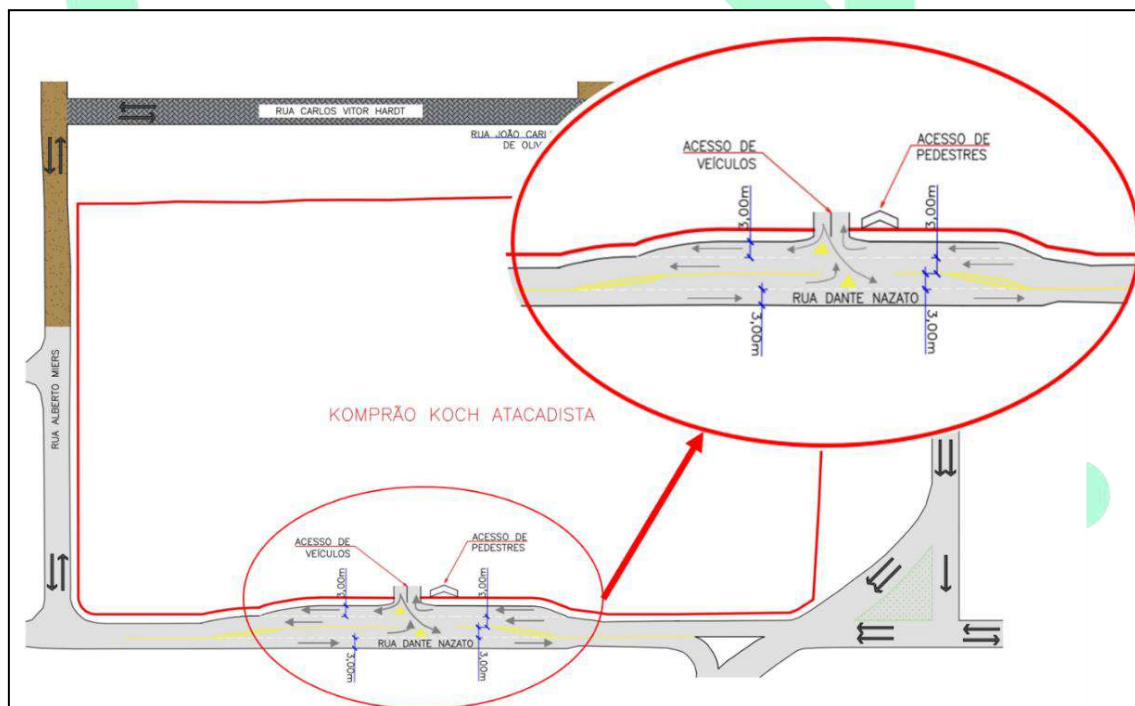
Novo layout proposto para entrada/saída do empreendimento.
